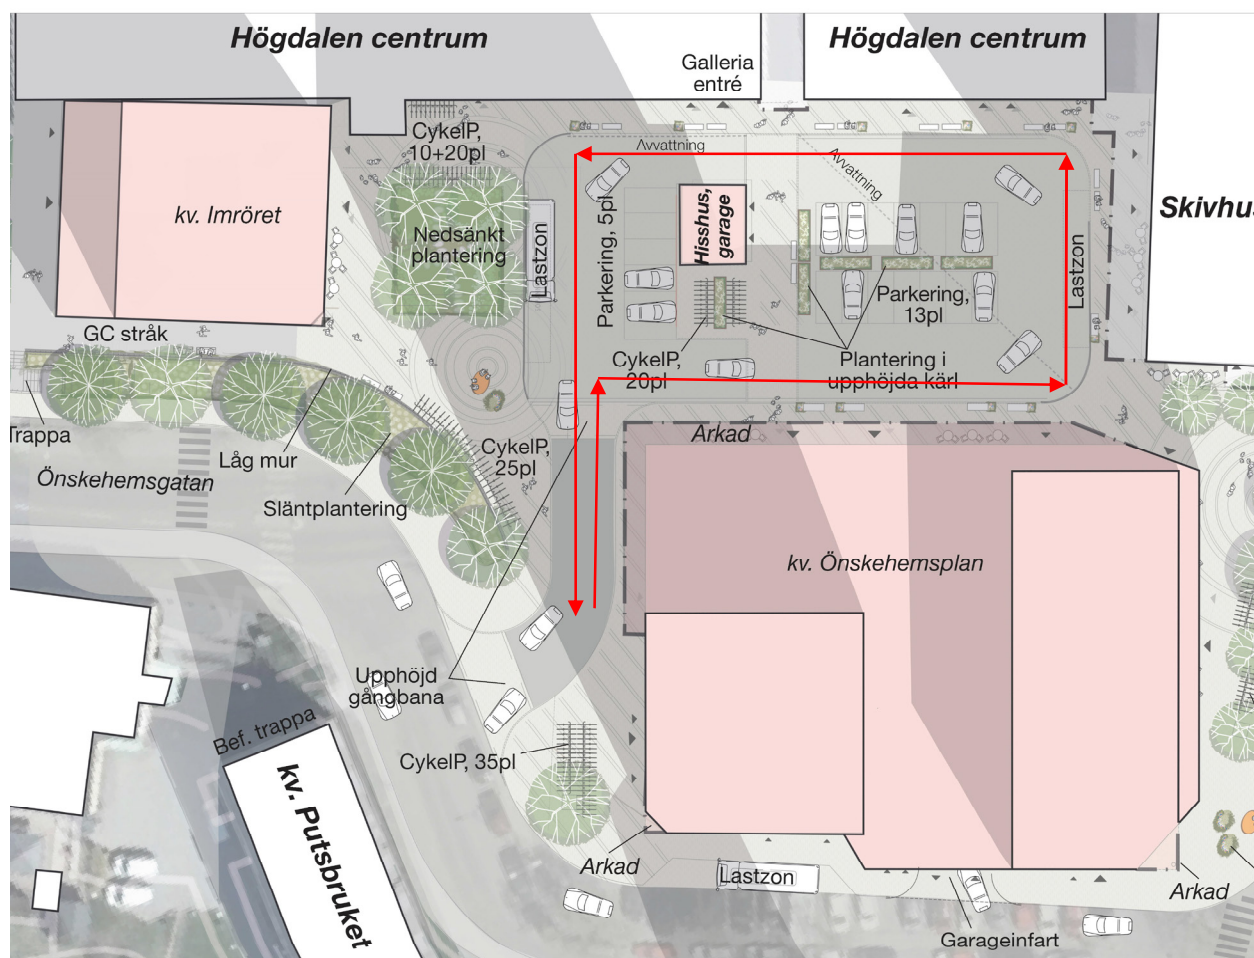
Övre garageplan på kvarter Önskehemplan. Planerad inlastningsyta är markerat med orange i figuren. Illustration 2024-03-18.
